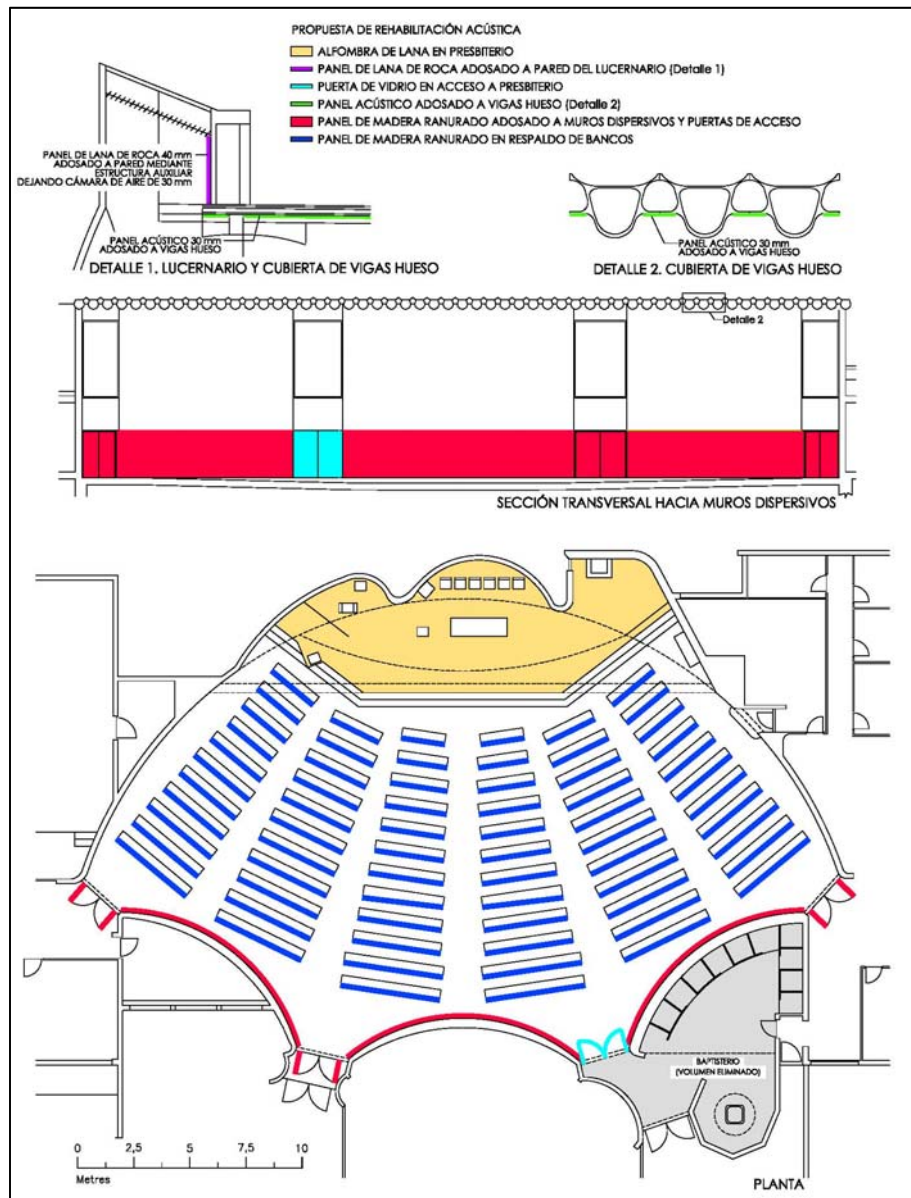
Planta y sección. Situación de materiales de revestimiento propuestos.
